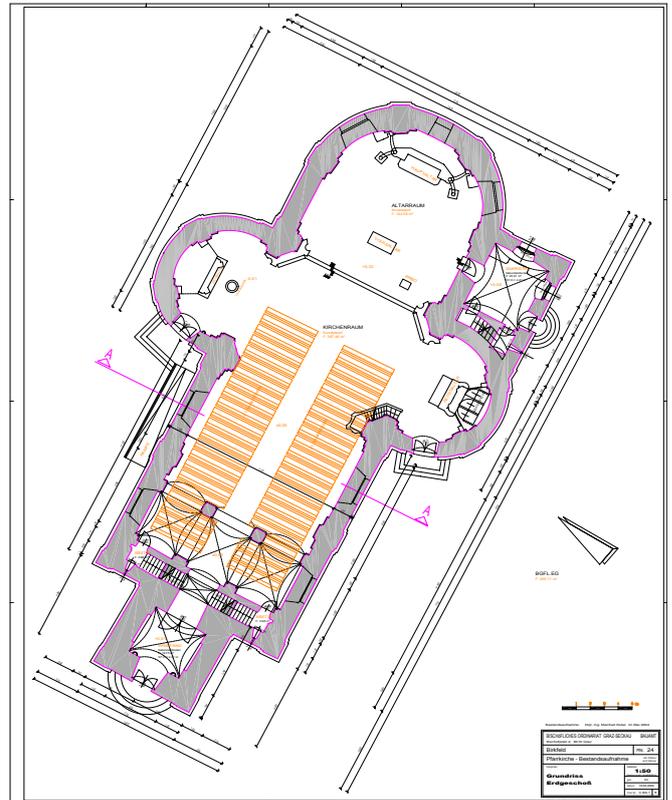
Grundrissplan der Pfarrkirche Birkfeld - EG
